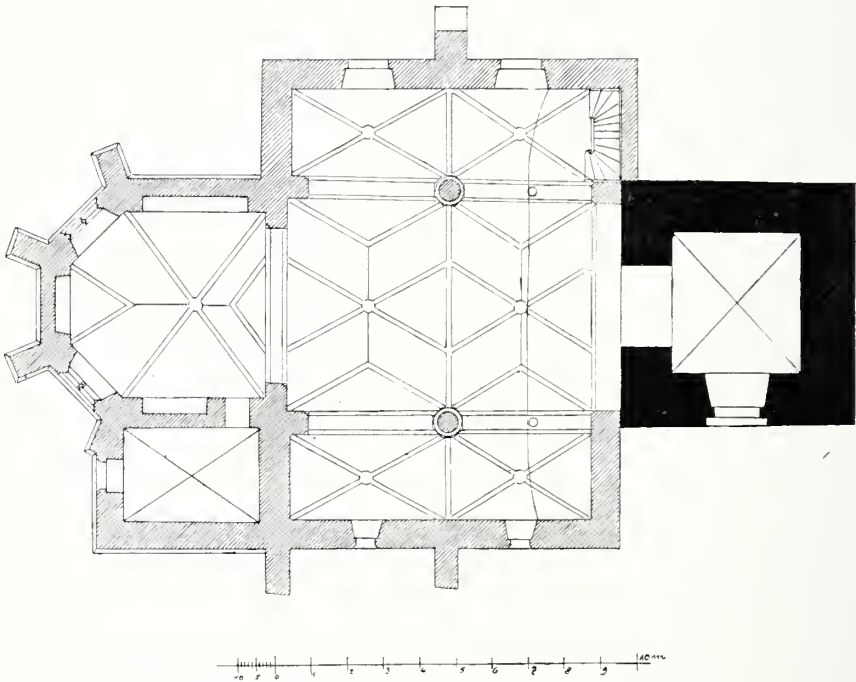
Schoenau. Grundriss der kathol. Pfarrkirche vor der Erweiterung.
